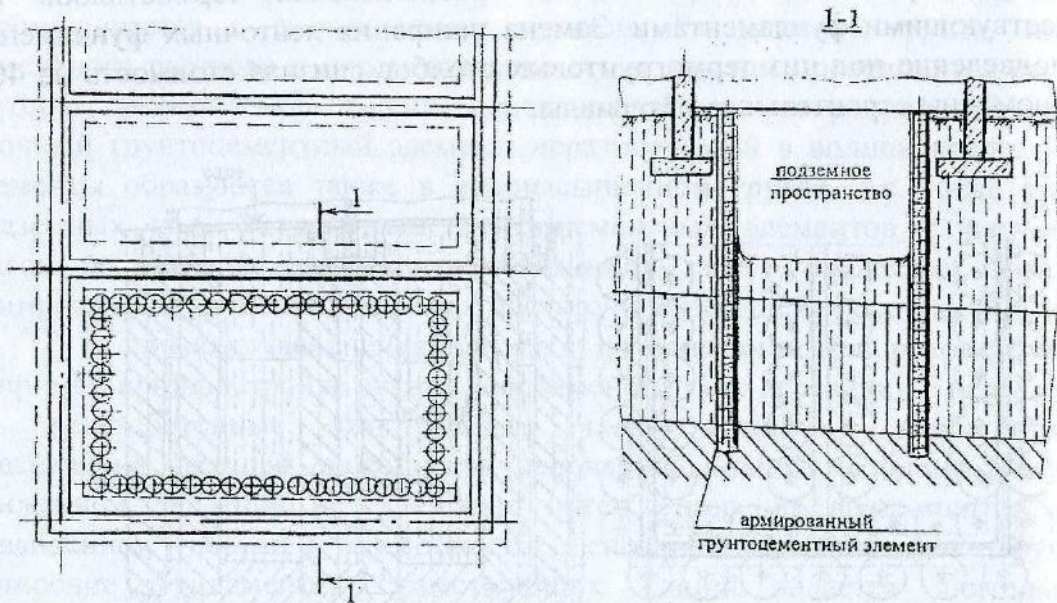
Устройство подпорных стен из армированных грунтоцементных элементов при использовании подземного пространства
